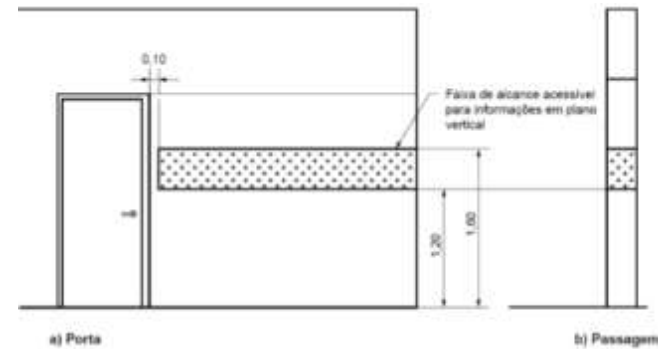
da NBR9050/20 - Sinalização de porta e passagem - Dimensões em metro
